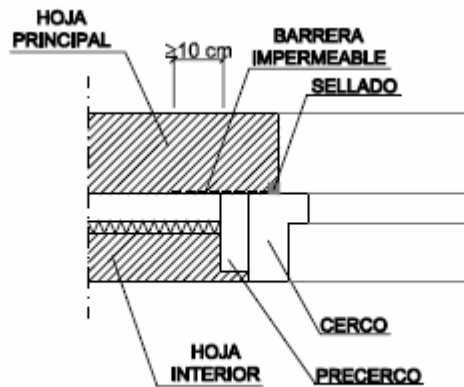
Ejemplo de encuentro de la fachada con la carpintería
